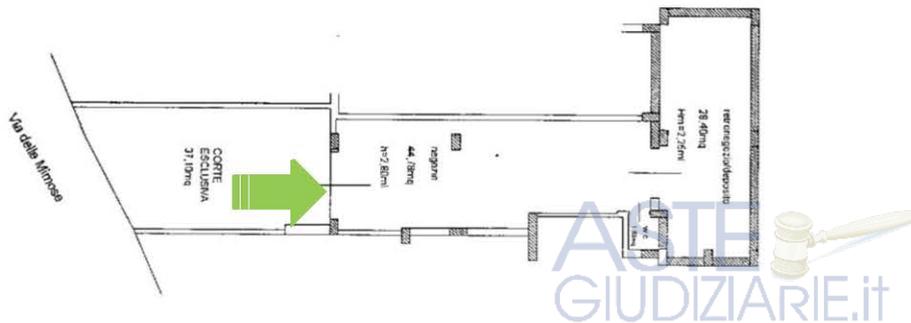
Planimetria dello stato reale dei luoghi, coincidente con la planimetria catastale
